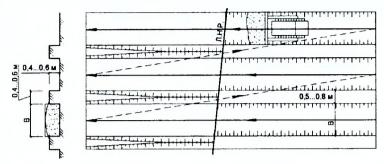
Ярусно-траншейная схема разработки и перемещения грунта бульдозером
